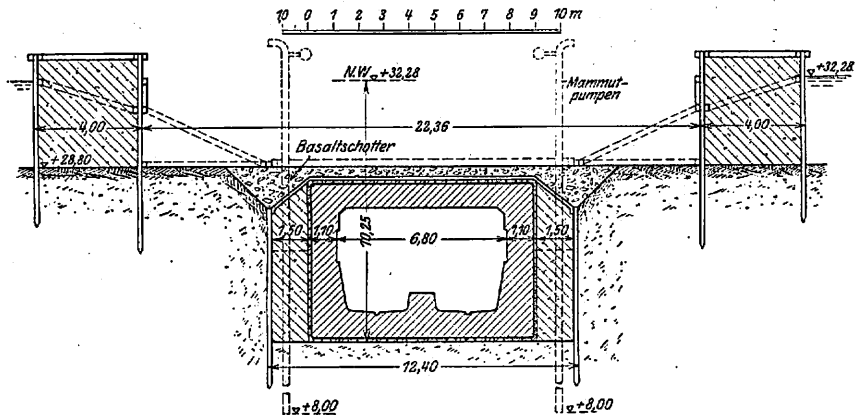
Tunnelquerschnitt Spreekreuzung Inselbrücke.
